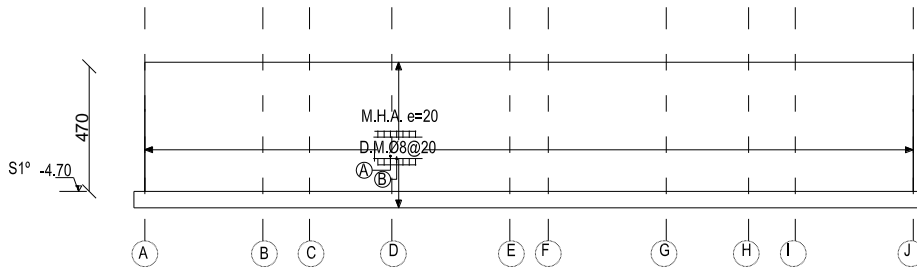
Elevación eje 0 de edificio aislado. Esc 1:300
